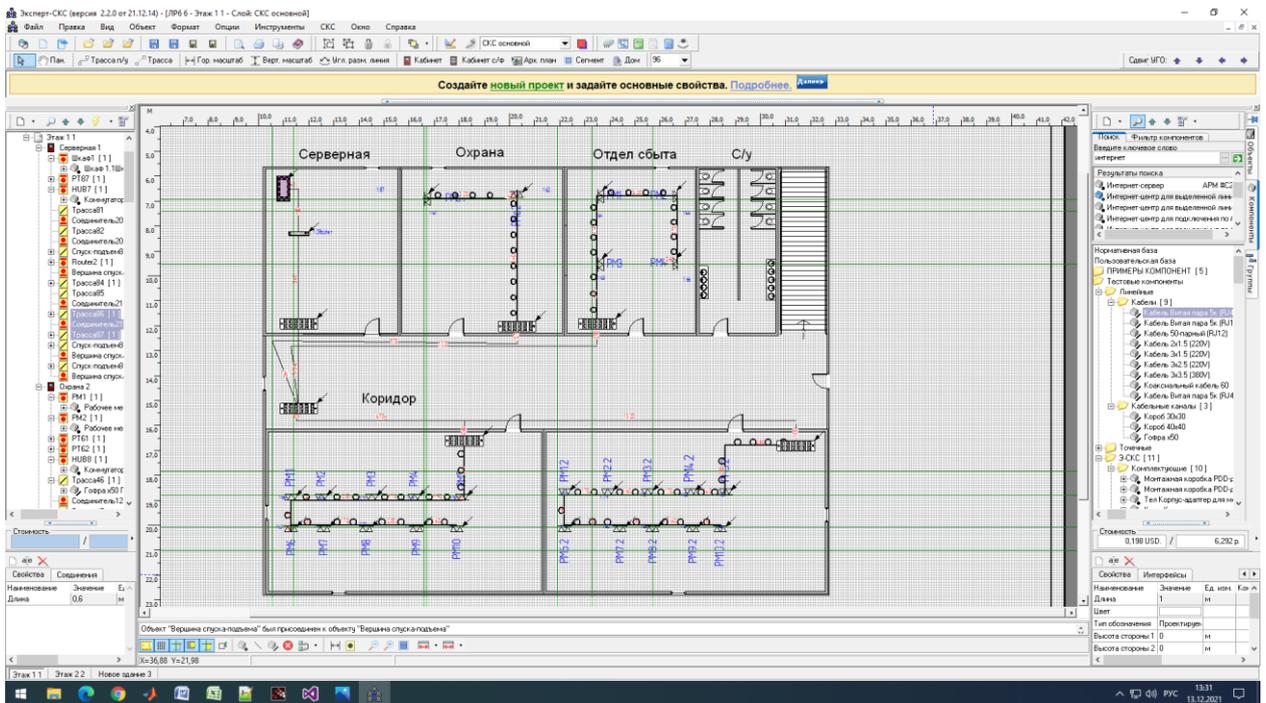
Трассировка и кабели (главное здание первый этаж)
